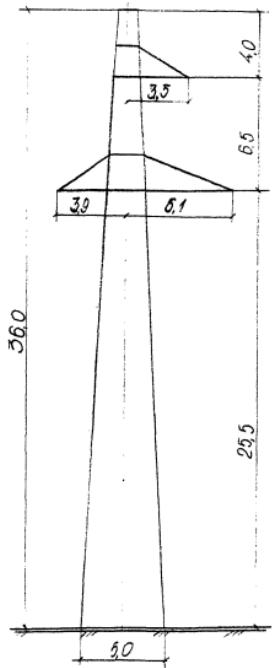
Одноцепные железобетонные опоры для ВЛ 220 кВ
